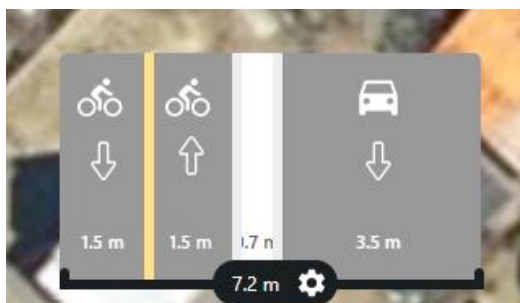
Pistes de solutions sur la rue Saint-Pierre - Option 2 - Profil en travers
